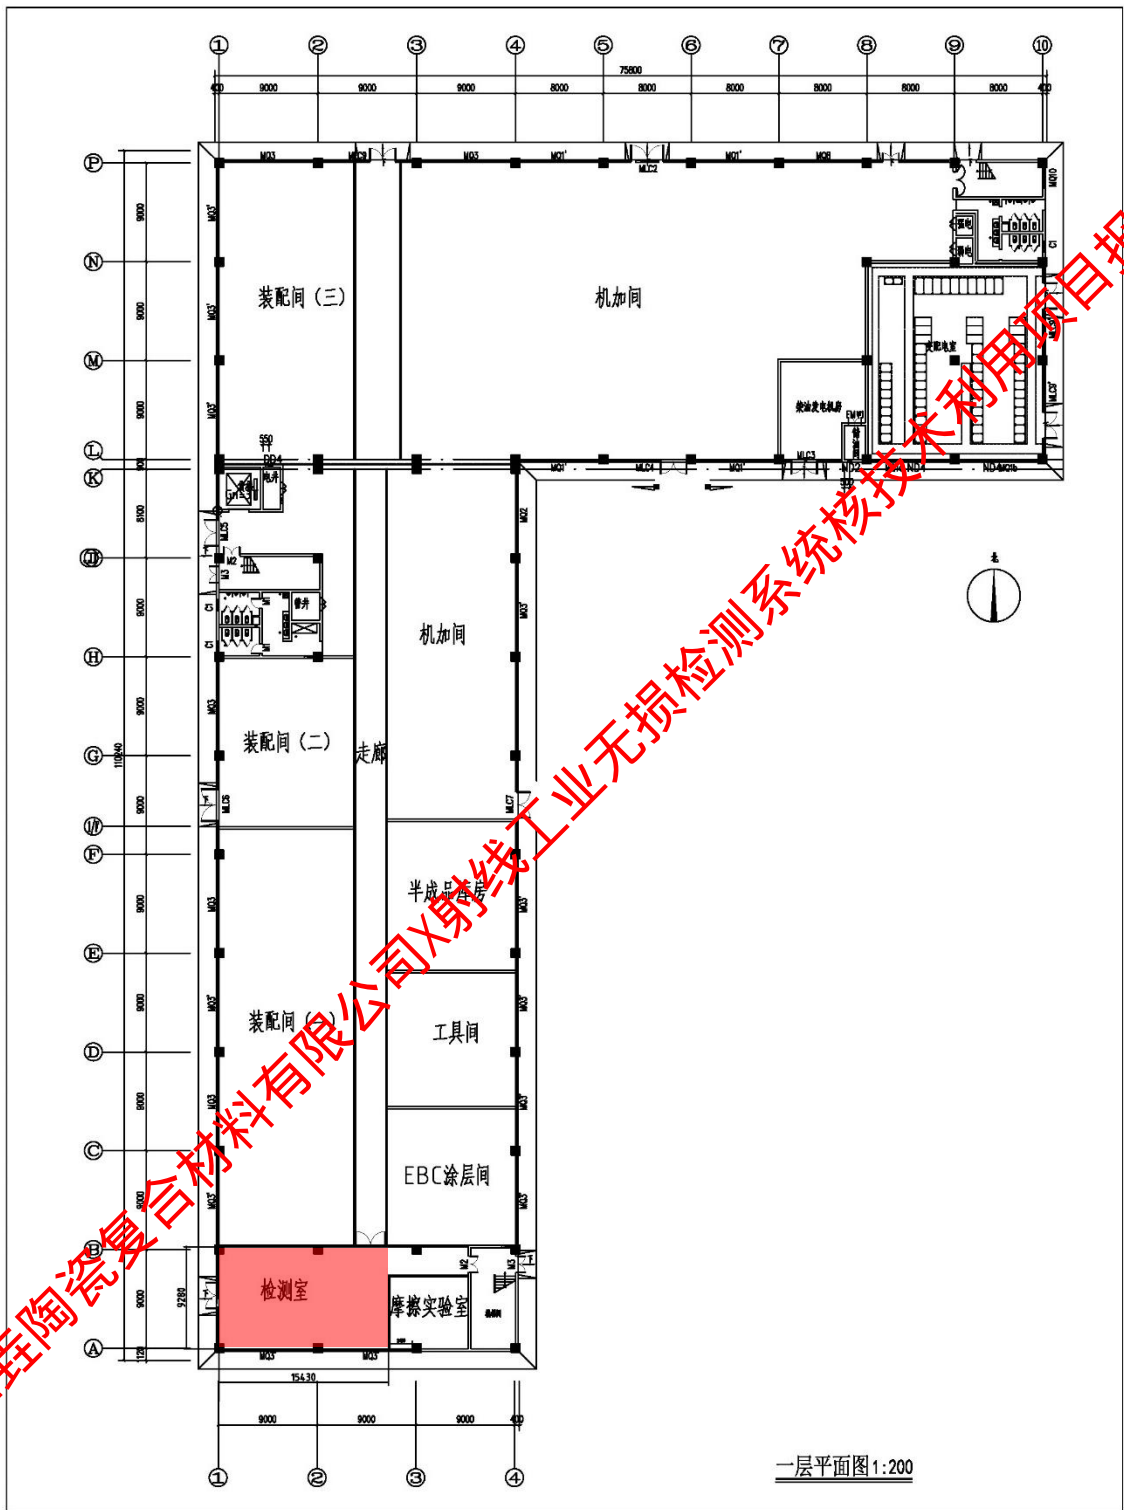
本次拟建检测室所在 3 号厂房平面布置图 (一层)
